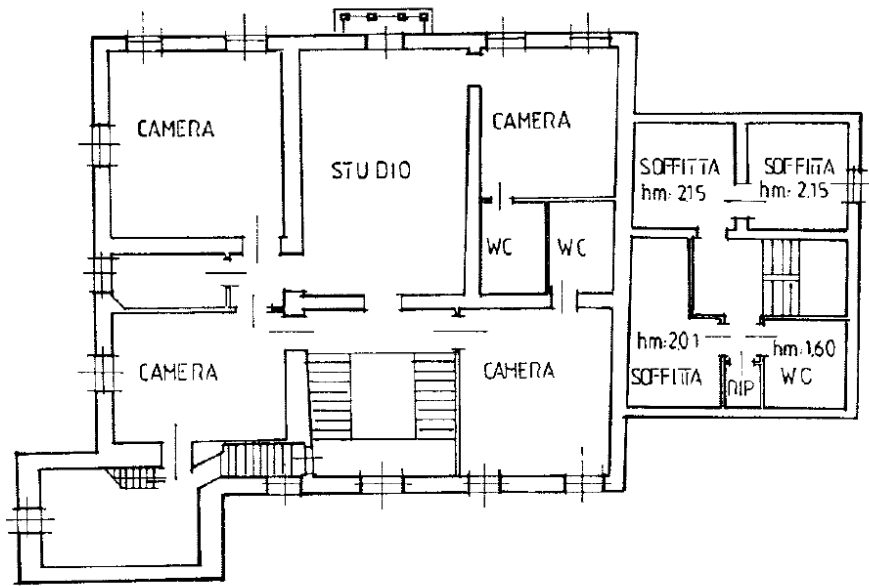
Estratto della planimetria catastale p.lla 415 (piano secondo).
